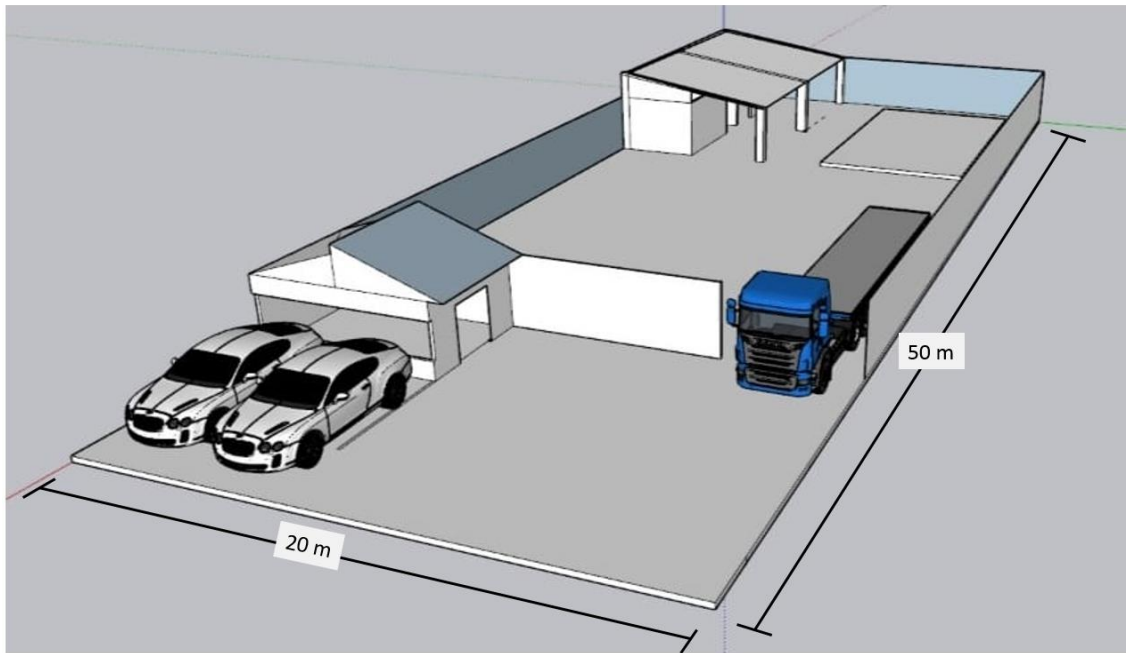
Diseño y distribución de la planta de producción de prefabricados en concreto.
